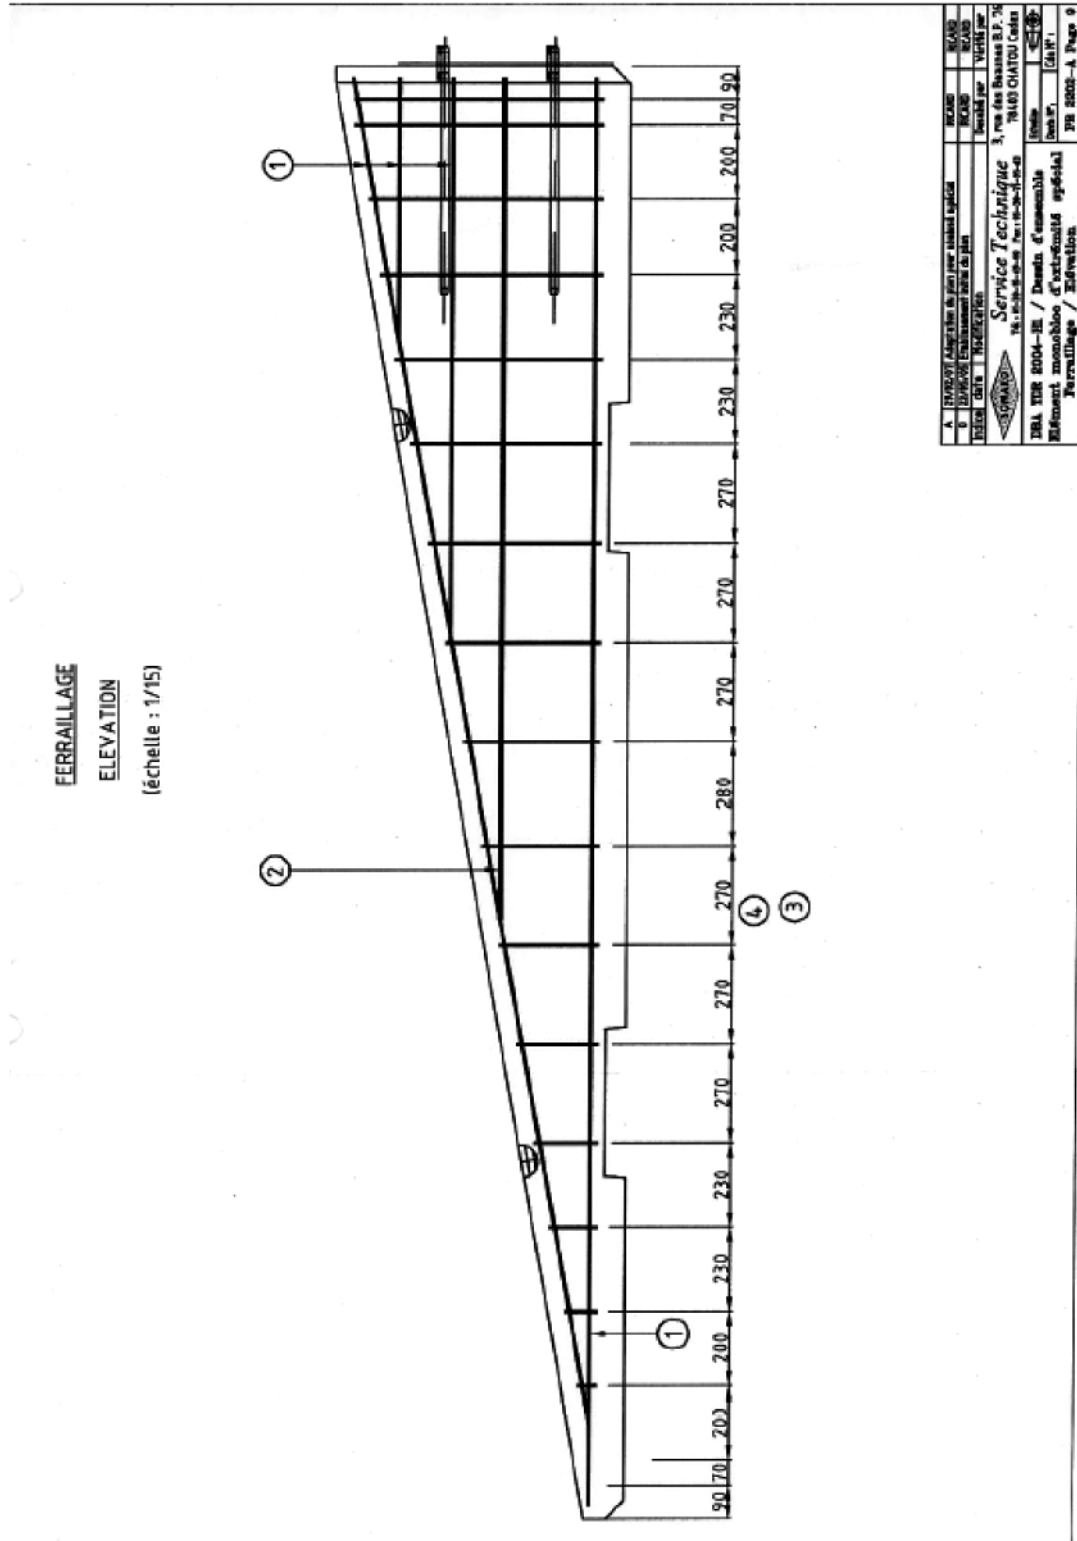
Elément d'extrémité abaissée. – Ferrailage. – Elevation
